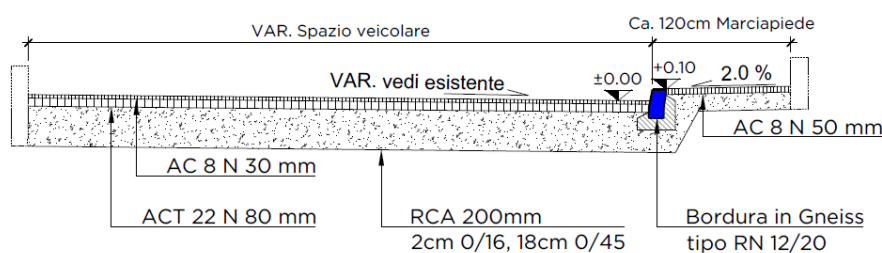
Stratigrafia pavimentazione strada comunale da piano d'appalto Ruprecht SA 6926-22-02-010
